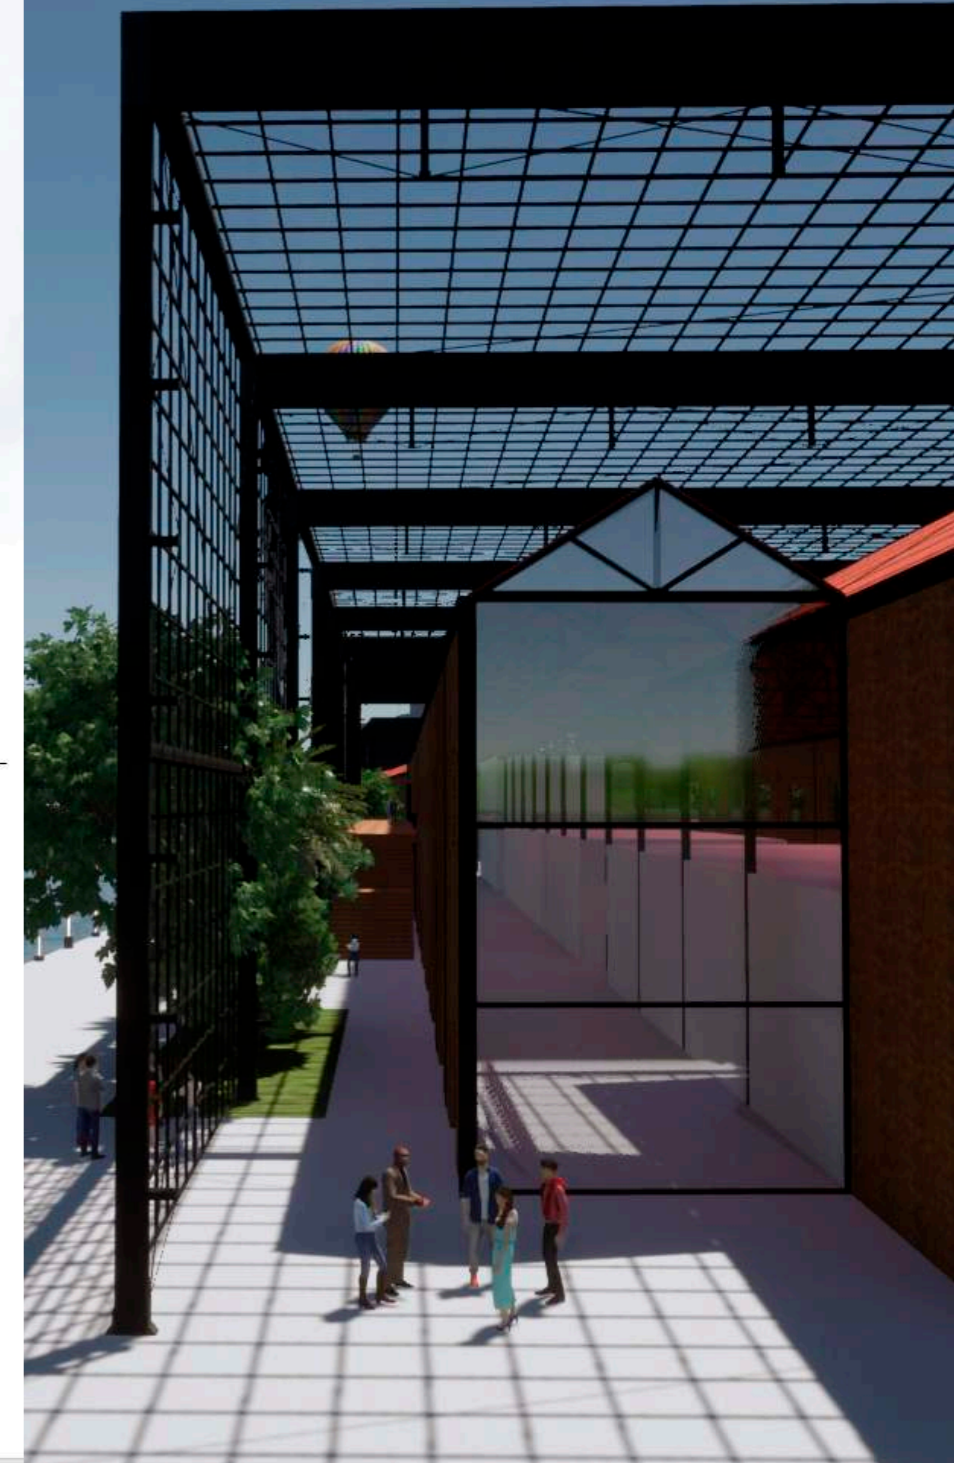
Perspectiva do armazém. Fonte: Autora. 223
